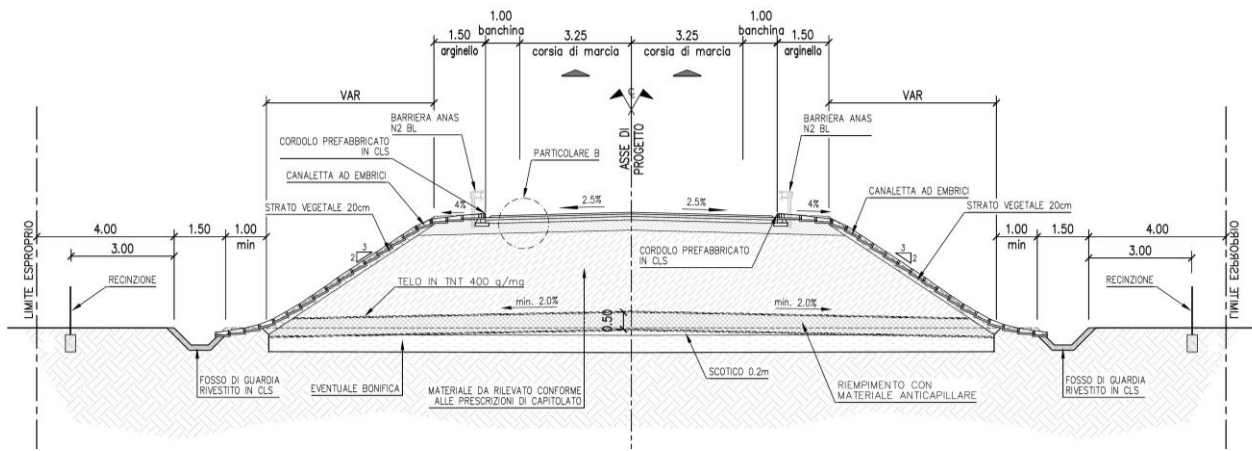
Sezione tipo in rilevato dell'asse secondario – Strada di Accesso alla Dorsale Consortile CASIC
